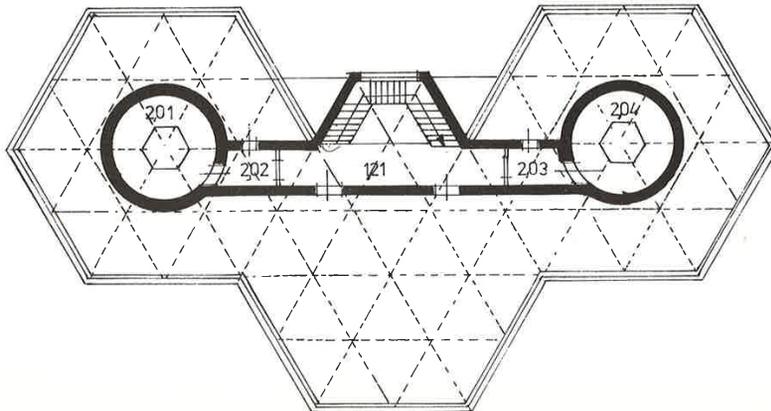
Grundrisse Bestand Observatorium Lustbühel
